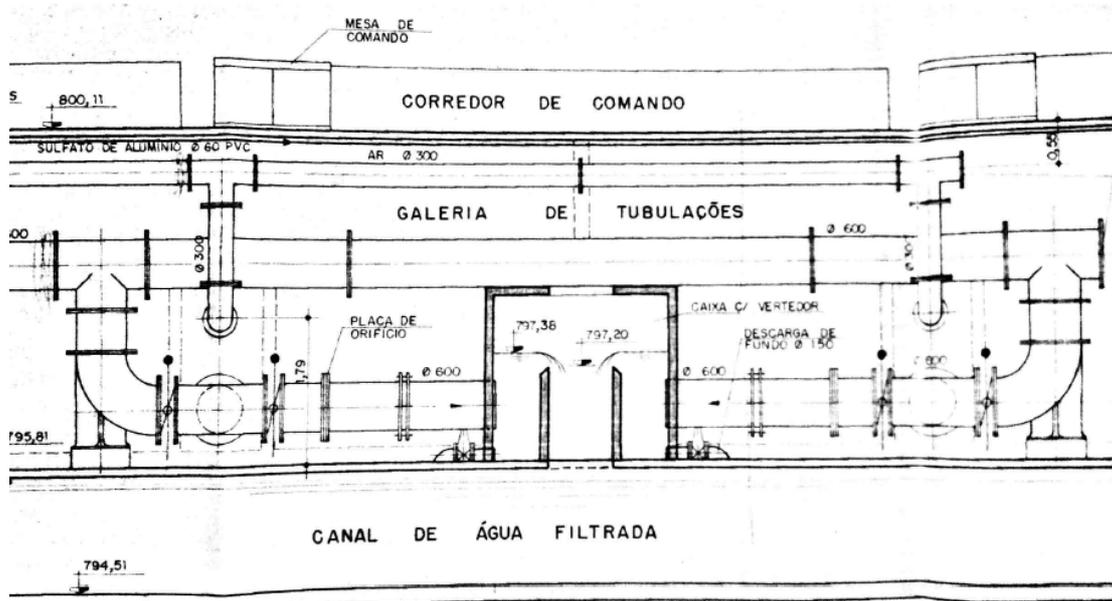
Corte de uma unidade de filtração típica da ETA Anhangabaú
